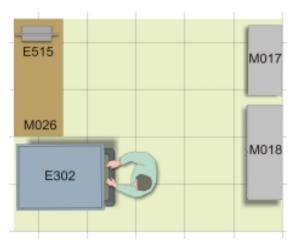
Layout Sala de Esterilização CME. Fonte; Ministério da Saúde
